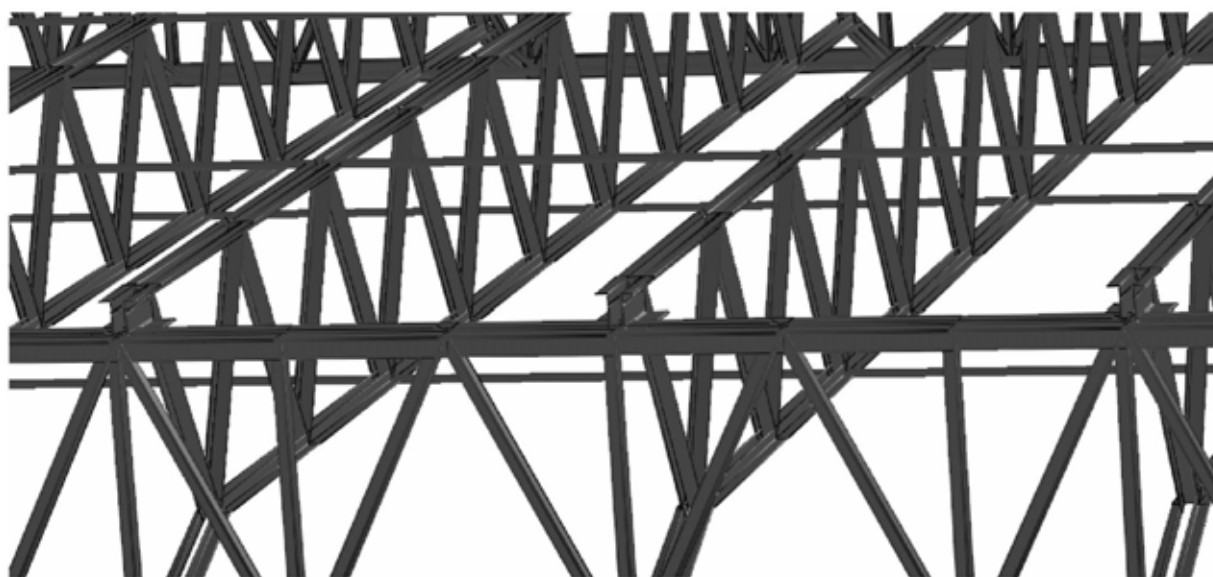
Esquema Indicativo do Apoio Típico de Joist sobre Viga Mestra
